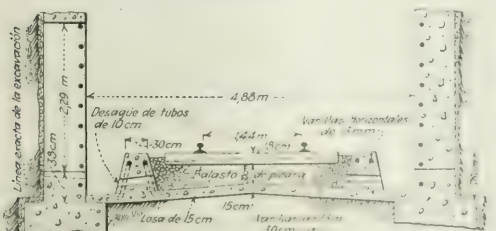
BASE DE HORMIGÓN Y CUNETAS PARA VÍA CON BALASTO EN TÚNELES
